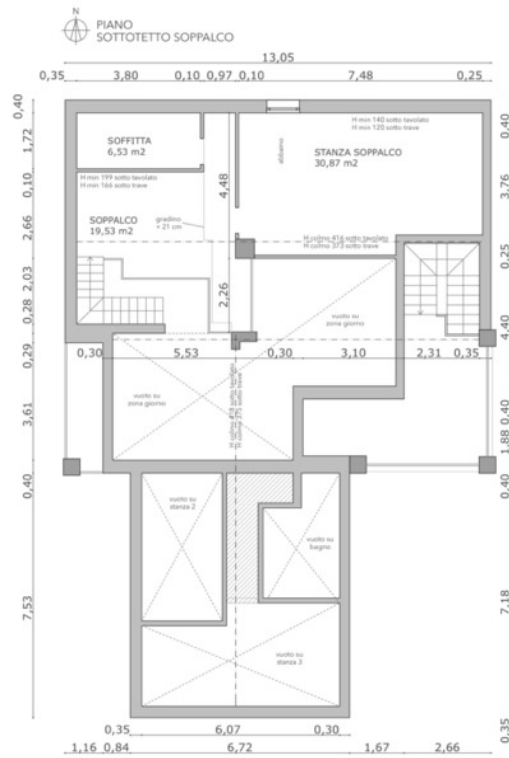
Planimetria piano sottotetto soppalco (non autorizzato)
